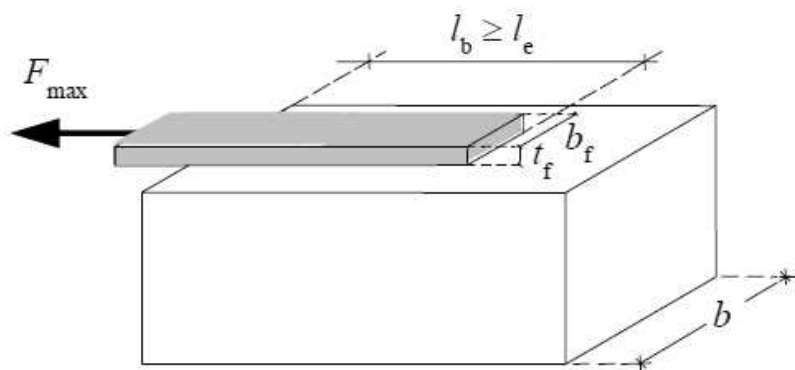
Gjatësia e lidhjes (ankorimit) të FRP në elementin betonarme
